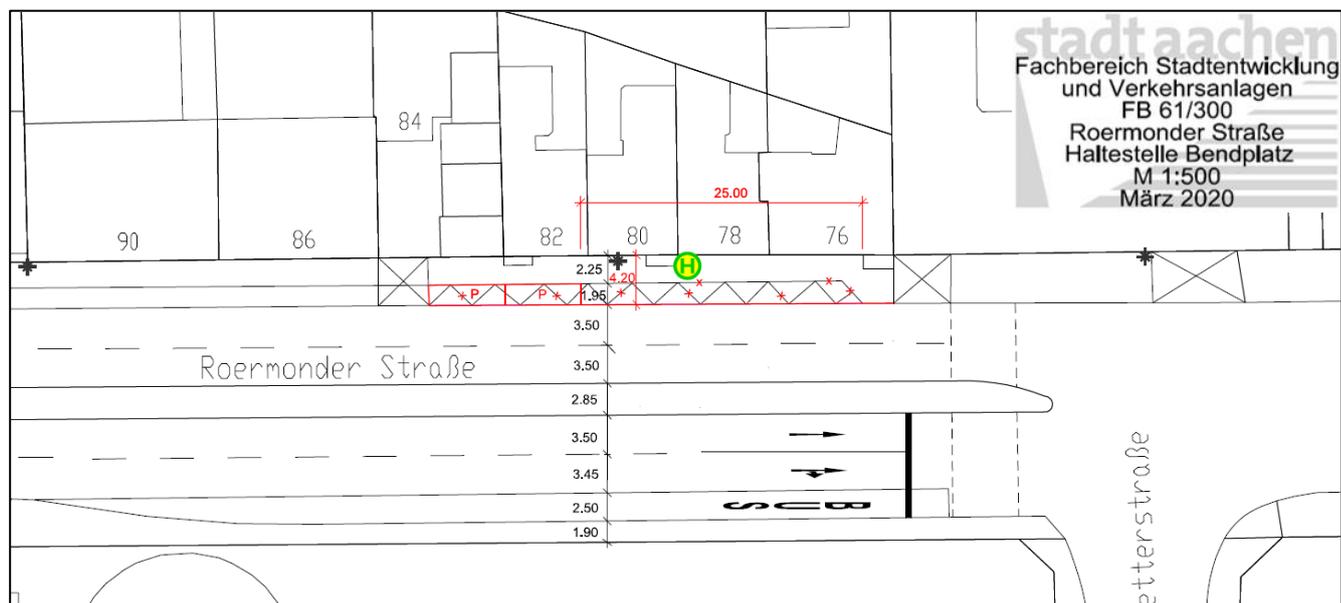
Geplante Fahrbahnrandhaltestelle für den Haltepunkt „Bendplatz“ in Richtung Laurensberg
